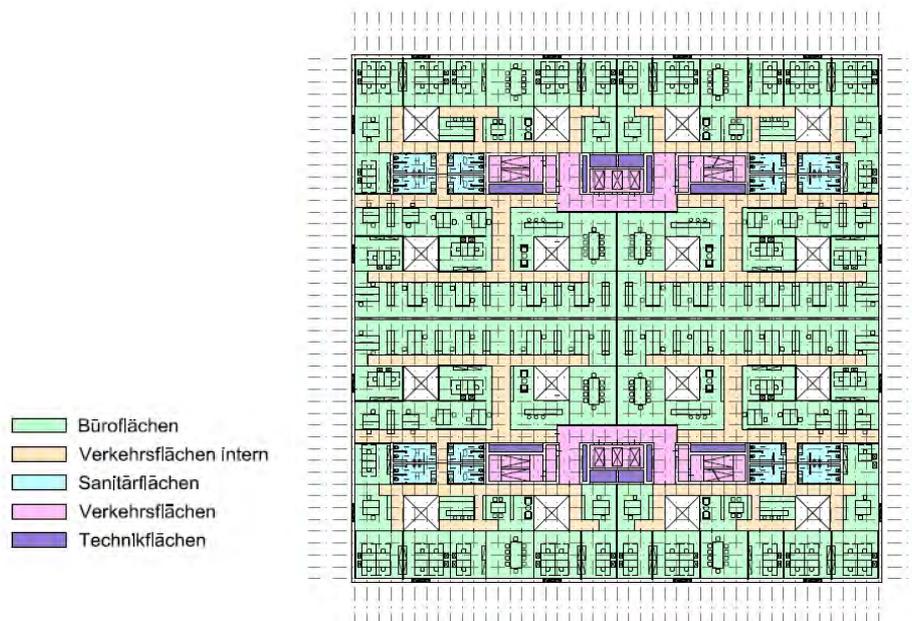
Grundriss des Neuentwurfs "Lichtfänger" mit Flächennutzung erstellt durch ATP Sphere
